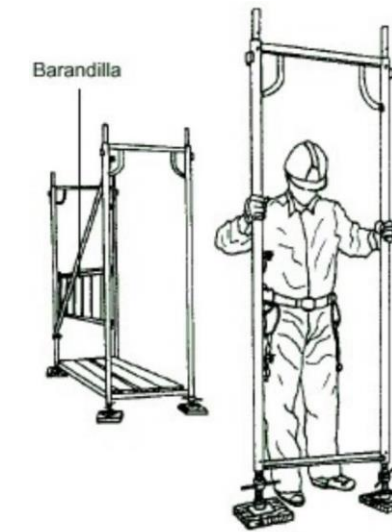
Colocación de las barandillas y posicionamiento del siguiente suplemento
